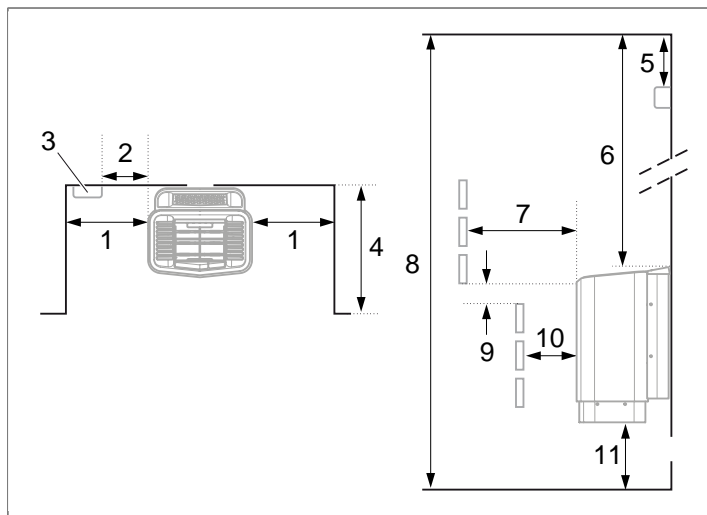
Montaż sufitowy czujnika pośrodku pieca, patrząc od przodu i z boku
